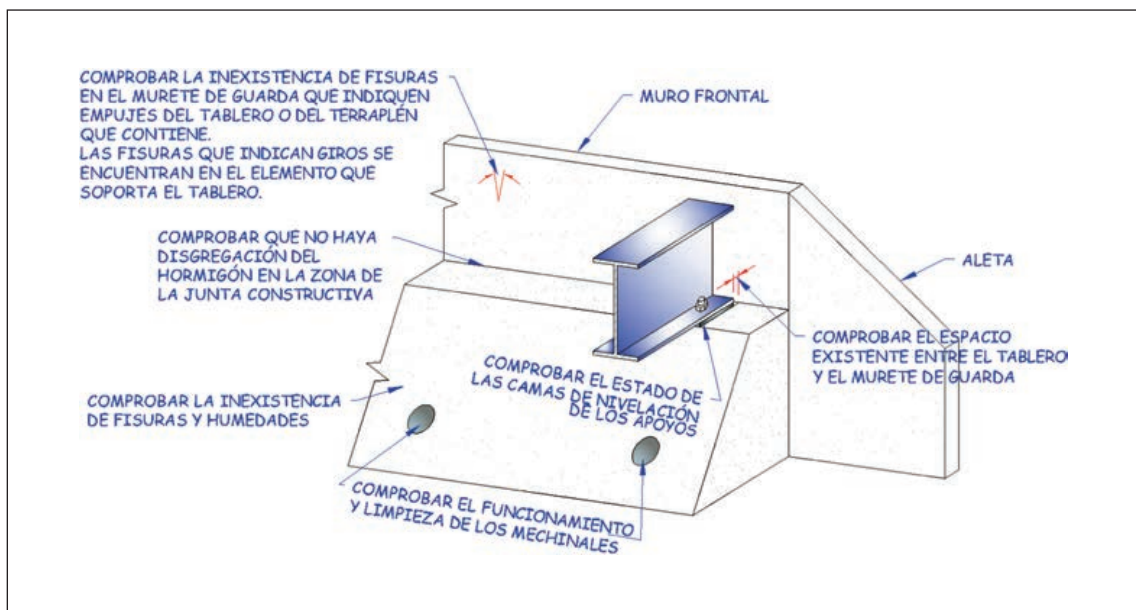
ALGUNAS COMPROBACIONES QUE SE DEBEN REALIZAR EN LA INSPECCIÓN DE UN ESTRIBO.
